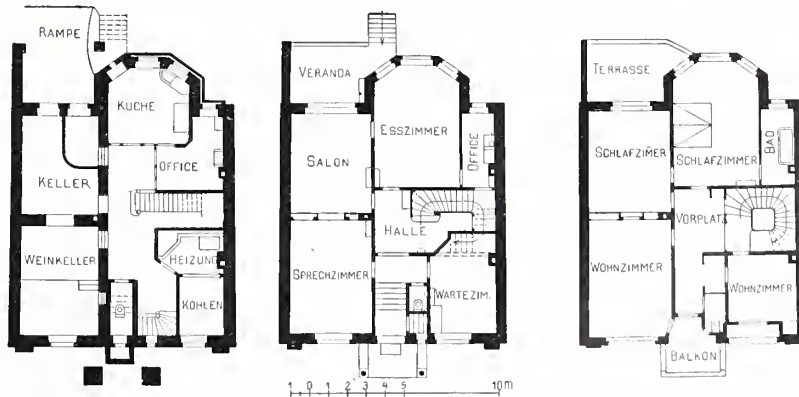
, 8, 9. Grundrisse vom Kellergeschoss, Erdgeschoss und ersten Stock des Hauses an der Arnold Böcklinstrasse. — Masstab 1 : 400.
